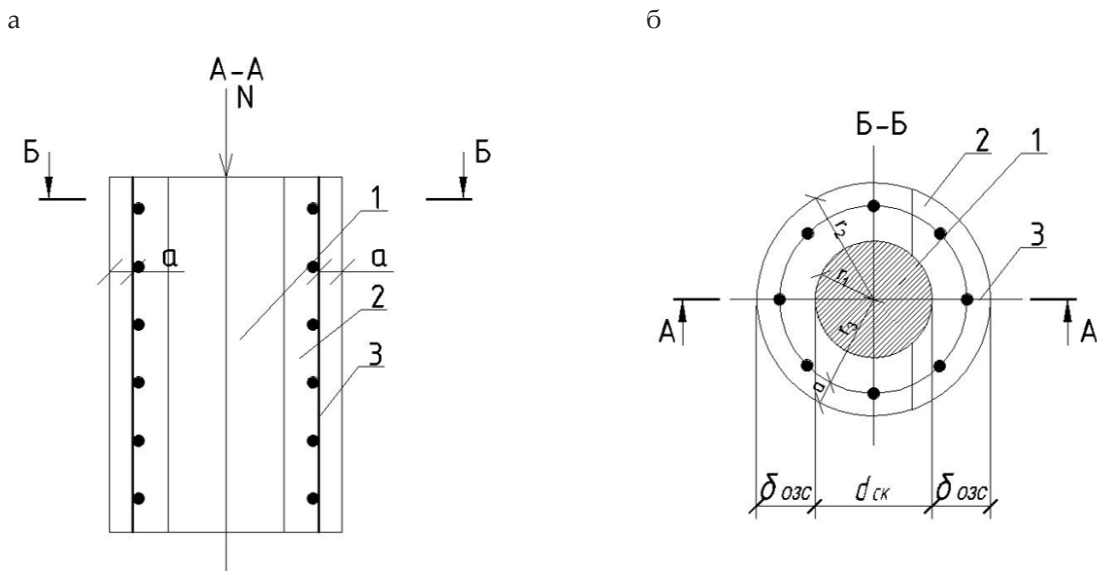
Схема армирования огнезащитного покрытия оголовка (Ø 300 мм) и средней части чугунной опоры (Ø 200 мм): 1 – существующая чугунная опора; 2 – огнезащитное покрытие толщиной 50–100 мм; 3 – продольная арматура 4Ø20 + 3Ø12; 4 – гнутые хомуты Ø4–6 мм; $\delta_{\text{оэс}}$ – толщина огнезащитного покрытия 50–100, мм; N – нагрузка на реконструируемую чугунную опору
